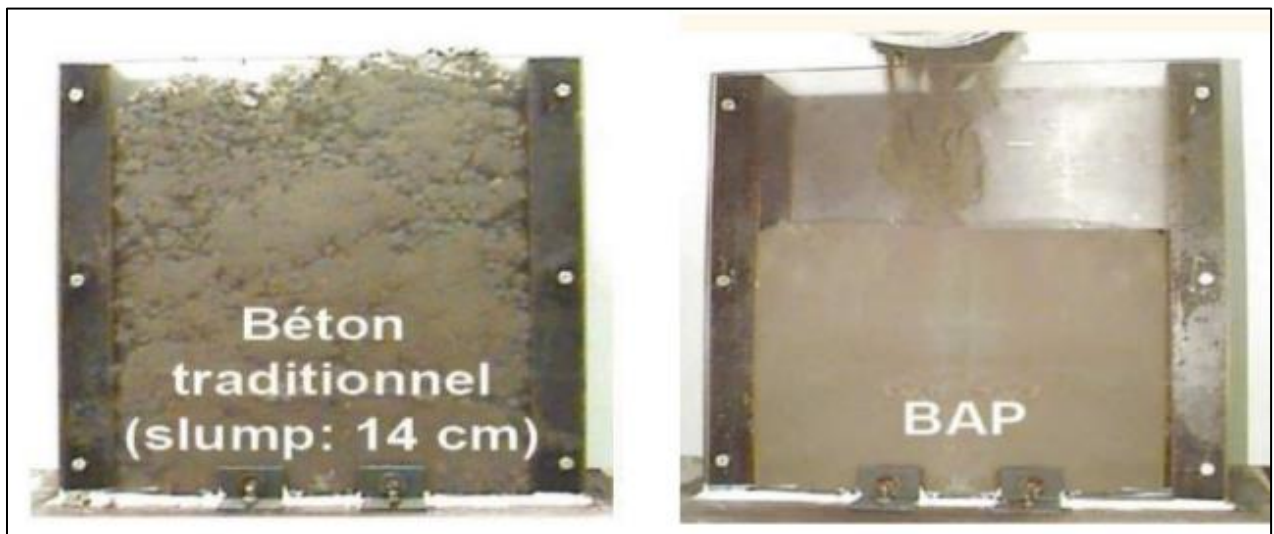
comparaison entre la mise en place d'un béton traditionnel et d'un BAP.
